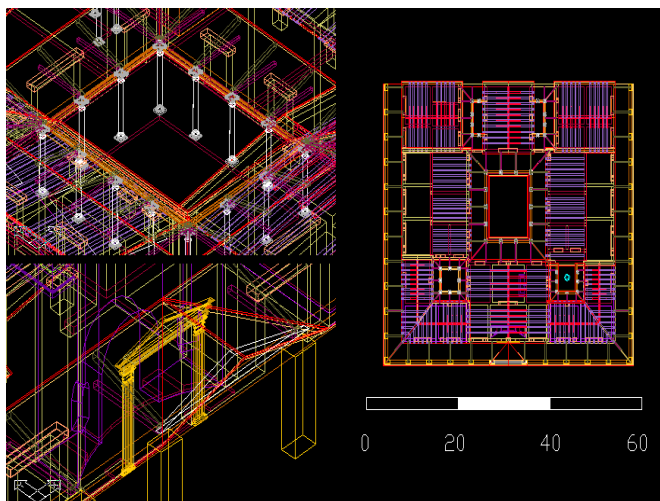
Planta y diversas isometrías de la casa del Planetario.
